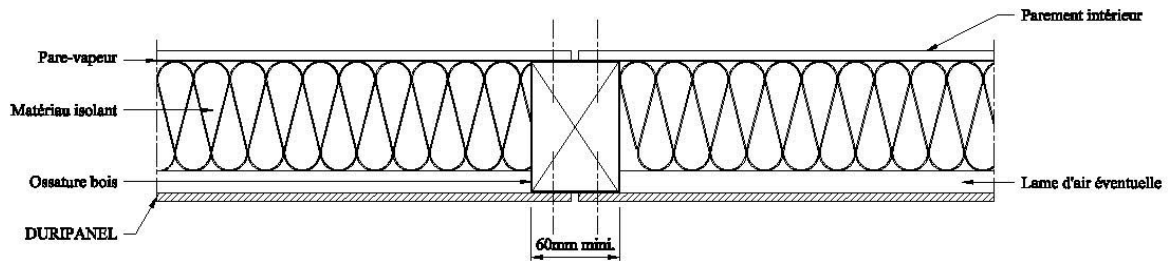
Coupe sur montant d'ossature avec joint vertical
